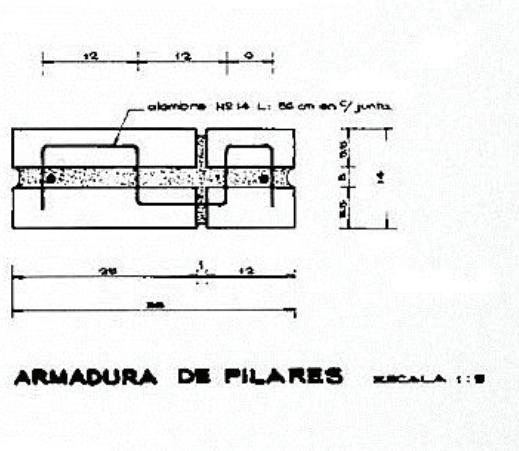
Detalhe de uma junta horizontal da pilastra com estribos em S e a passagem das armaduras verticais na separação de 4 cm. entre os tijolos de espelho. (*- 3).
